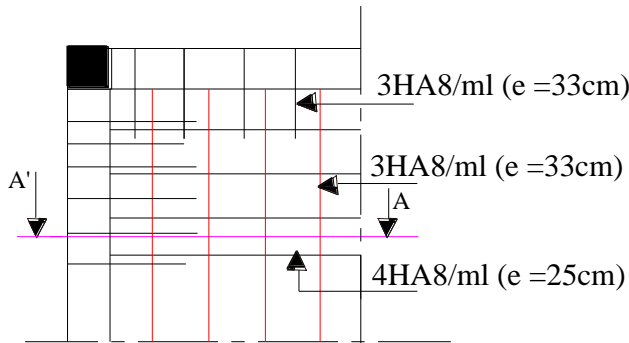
Schéma de ferrailage de la dalle au-dessous de l'ascenseur.
